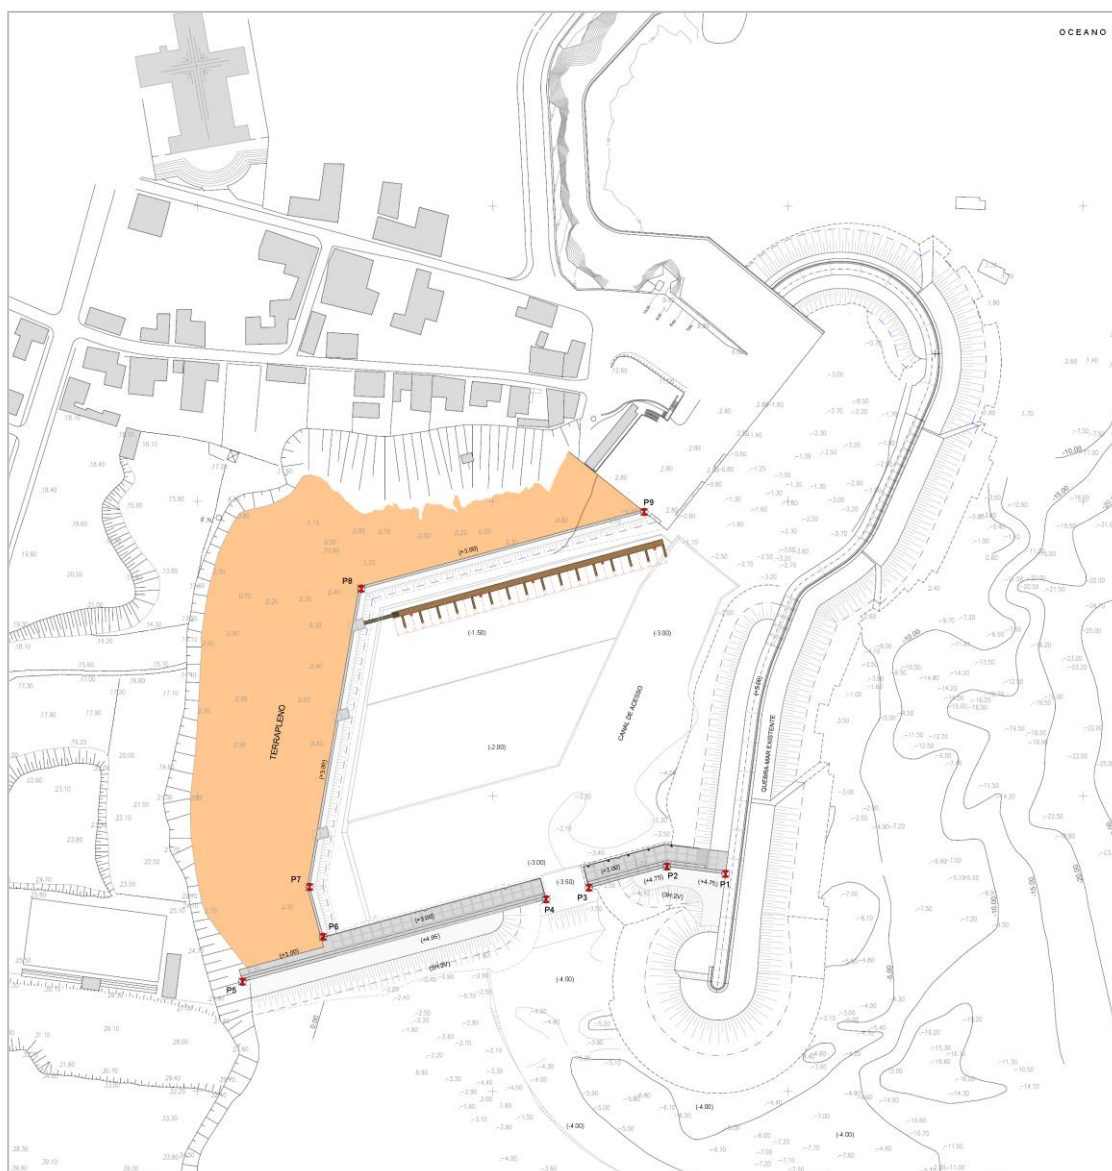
Planta geral das obras de melhoria do Porto das Poças
